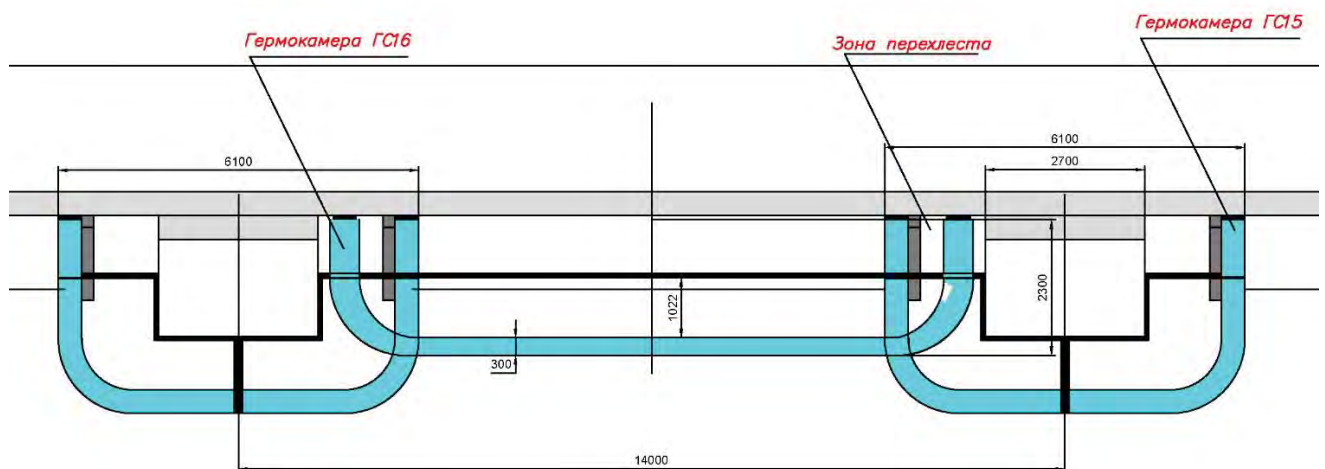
Схема перекрытия рабочих зон гермокамер
